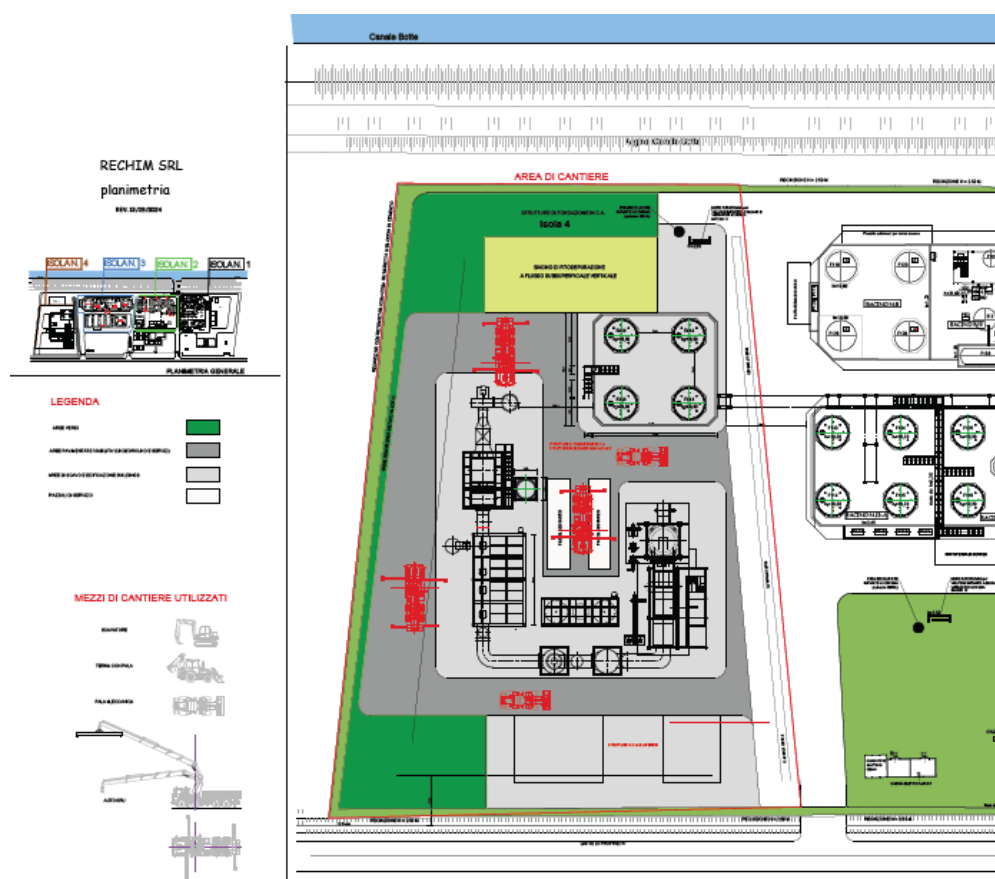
Stralcio planimetria con area di cantiere (delimitata con linea rossa)
